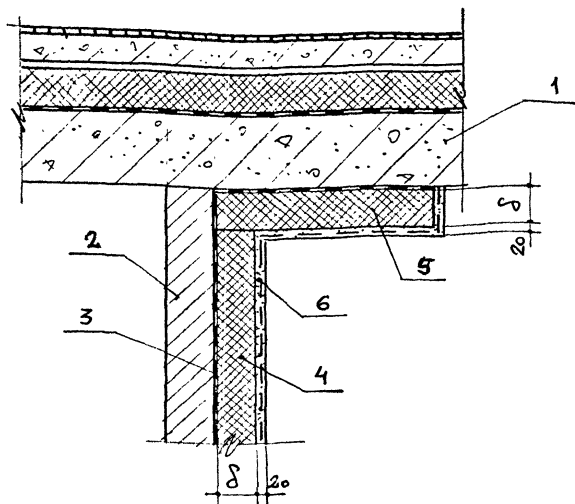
Трехслойные перегородки и видные стёкла к перекрытиям и окрытиям.
